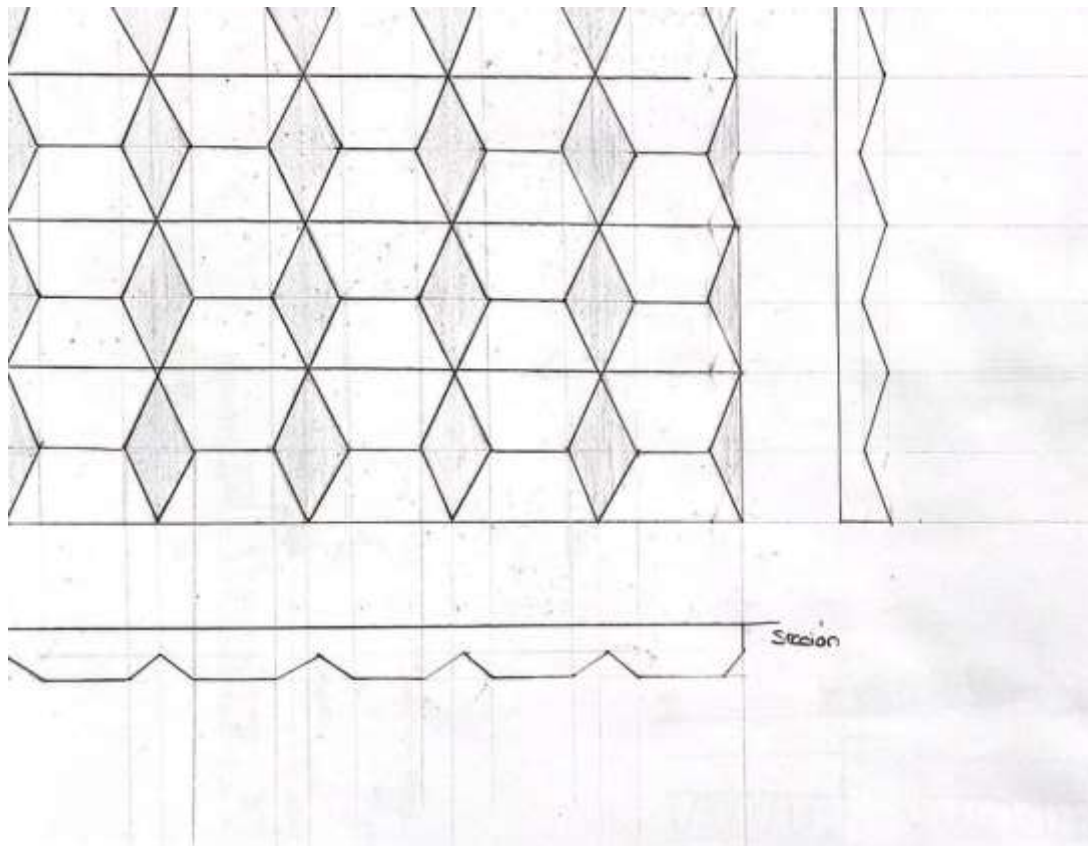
Plano fachada triangular. Fuente: Elaboración propia
